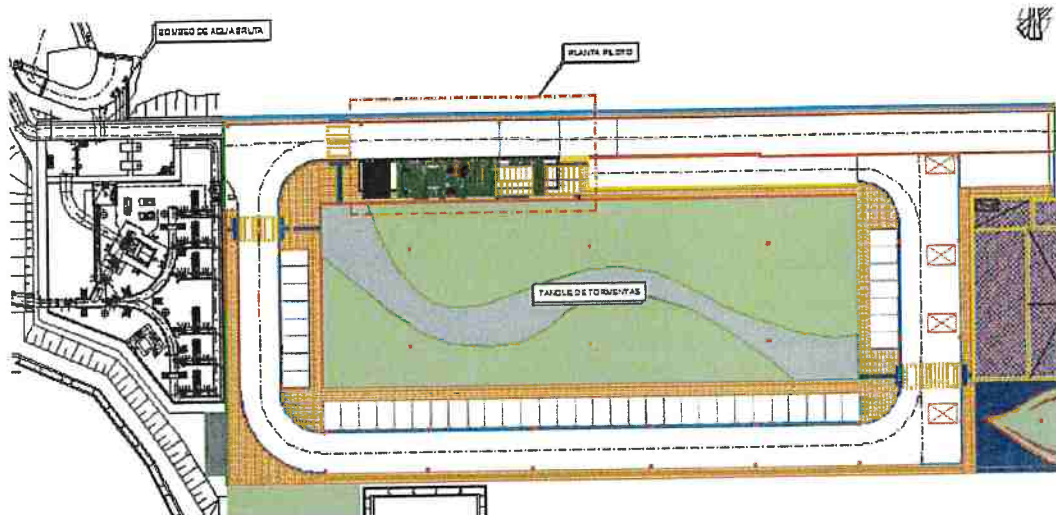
Localización de planta piloto en tanque de tormentas en Etxebarri.
